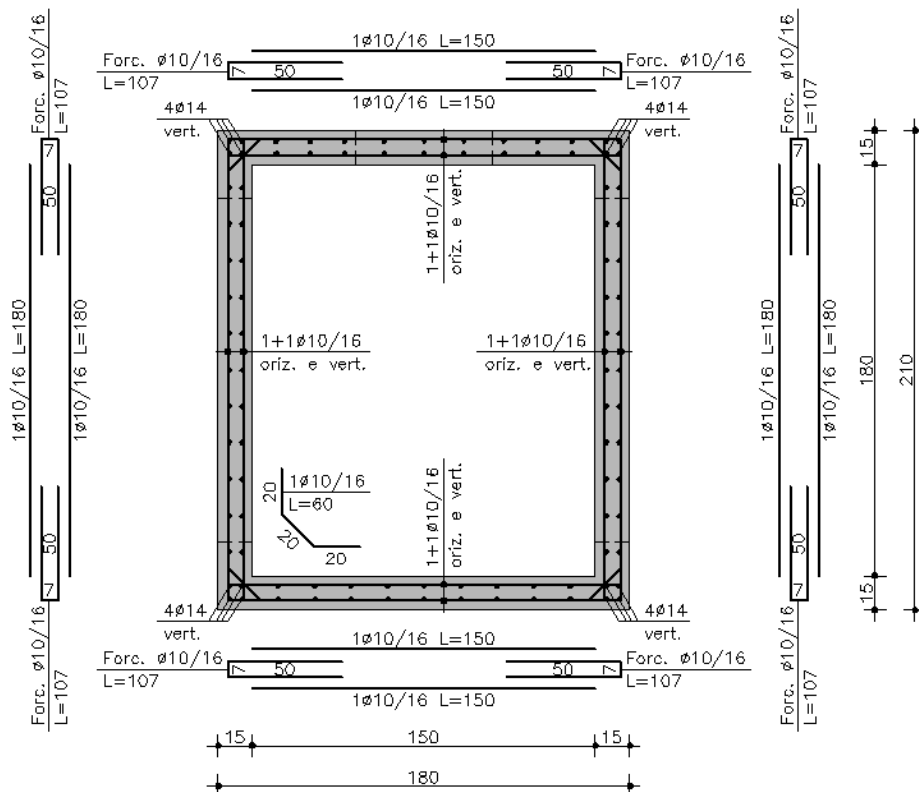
Pozzetto n. 2 - Sezione orizzontale D-D
